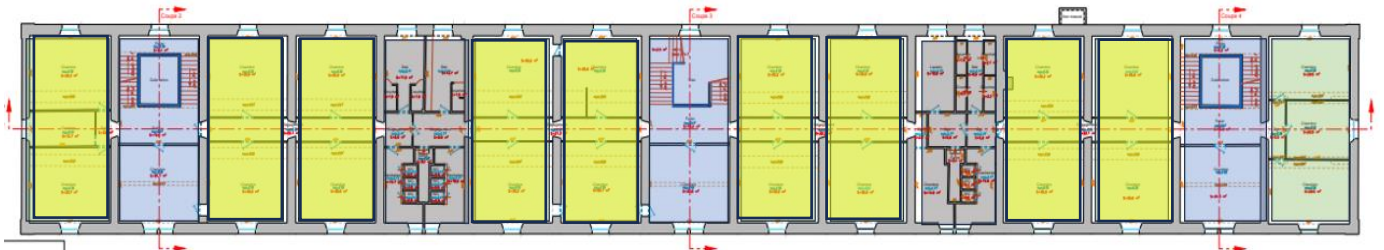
zonage selon les systèmes constructifs des planchers courants
